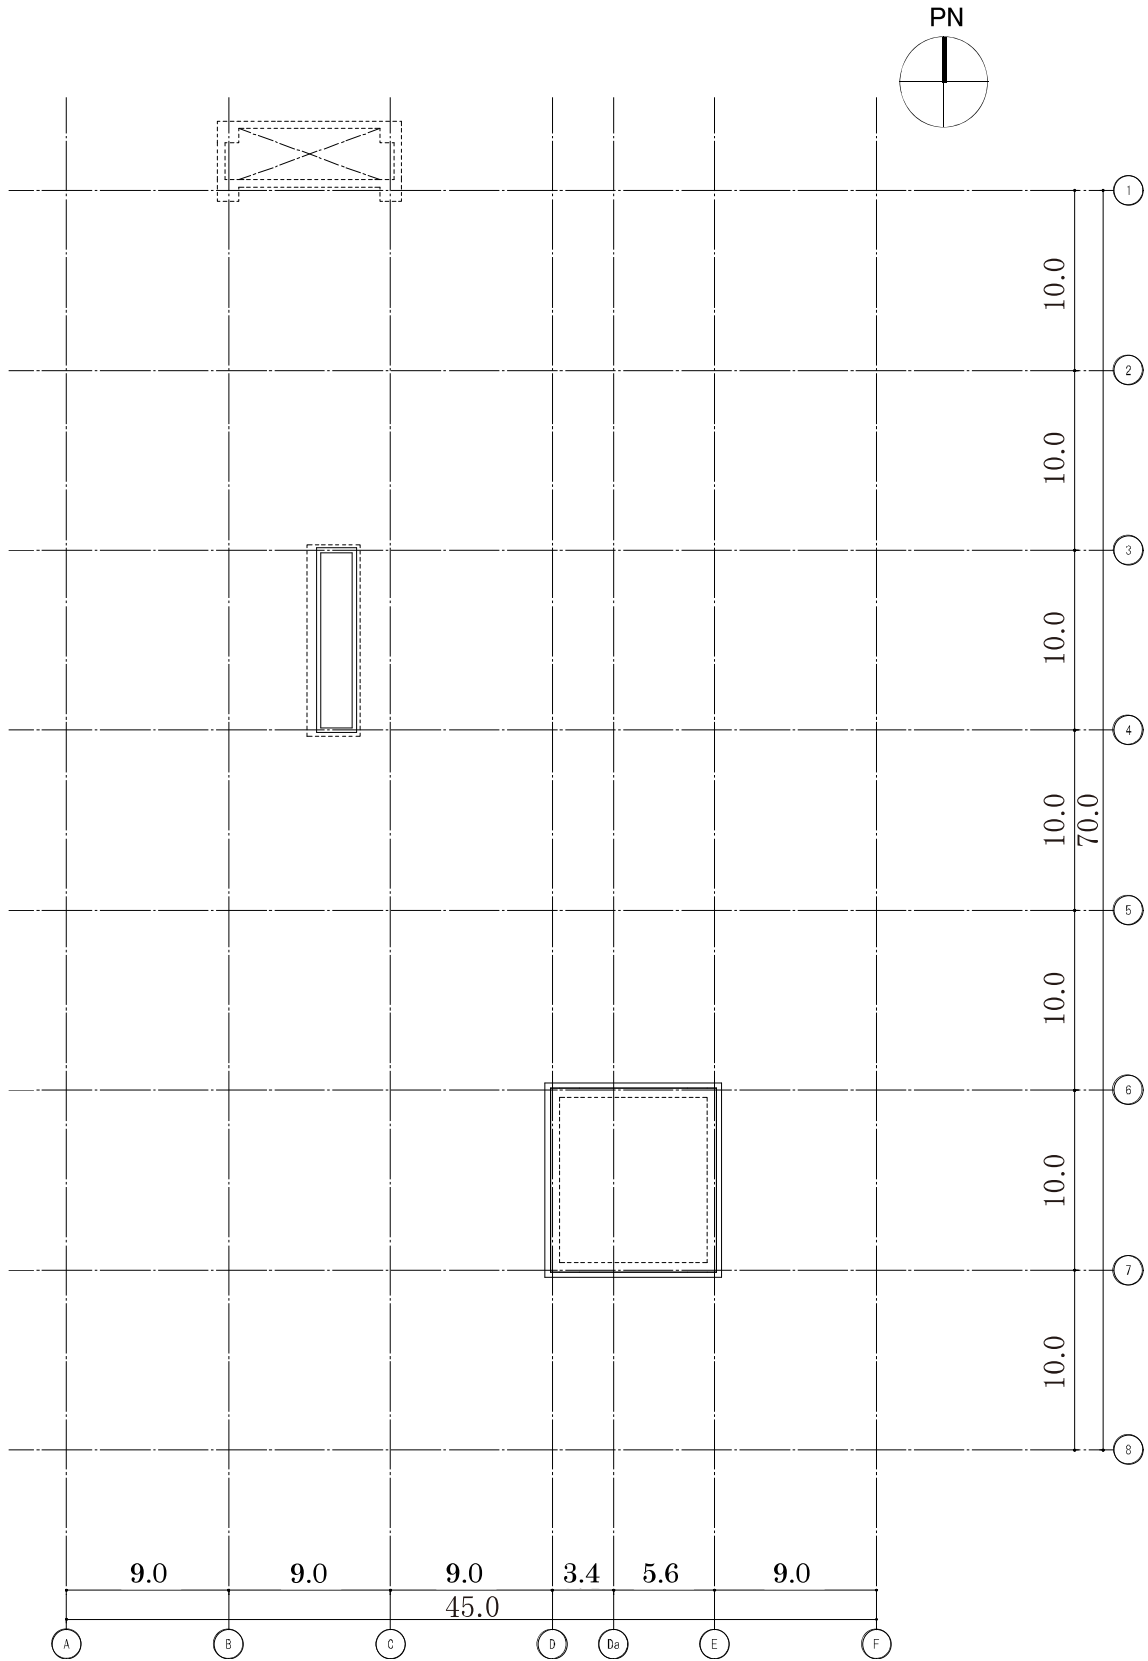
屋根平面图 (G. L. +29.30) (单位 : m)
